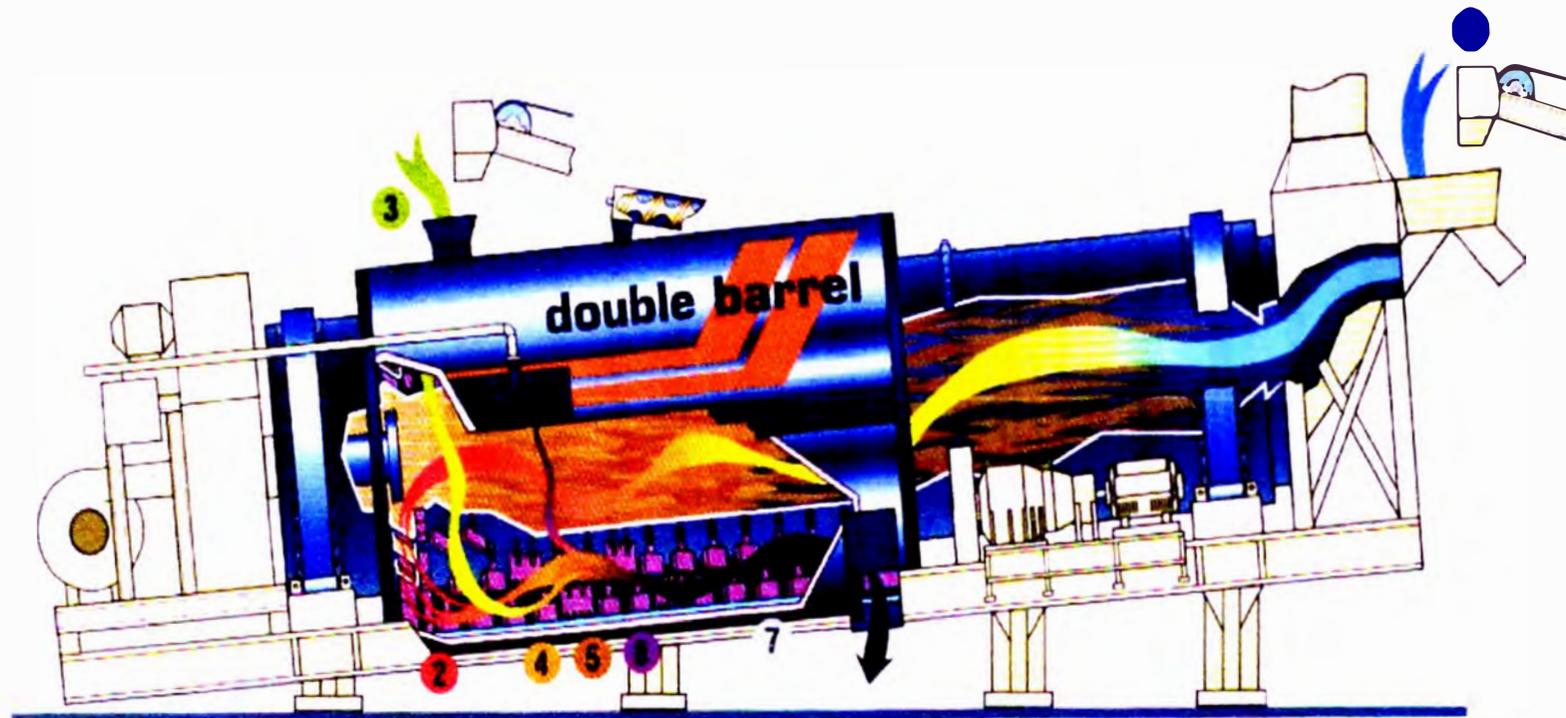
Layout de la planta con tambor mezclador de contraflujo Double Barrel de ASTEC
